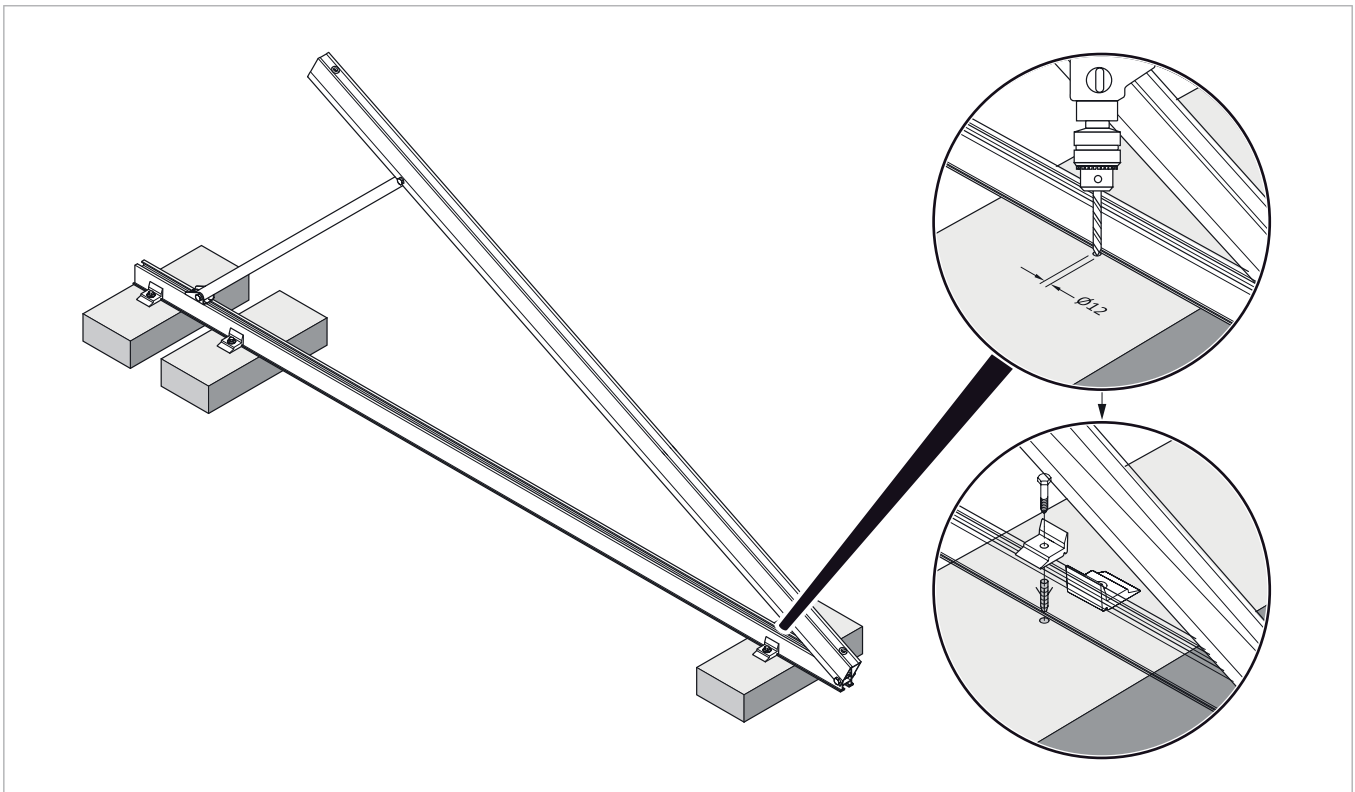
Montaje del soporte para tejado plano en piedra de hormigón
